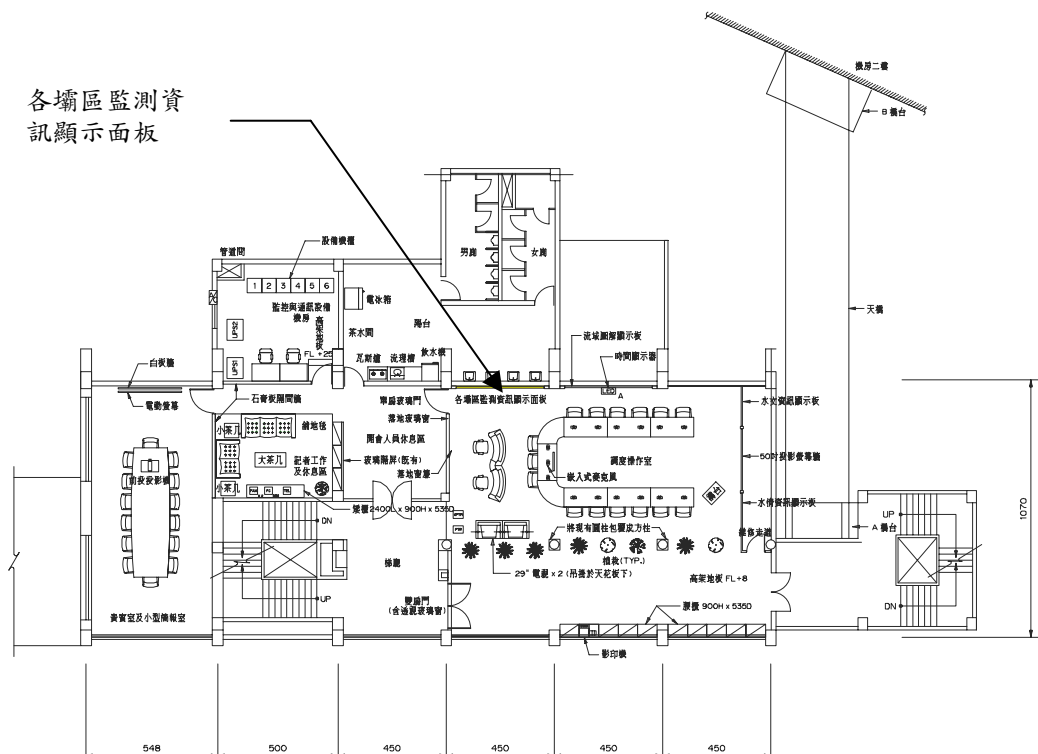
『各壩區監測資訊顯示面板』平面配置示意圖
